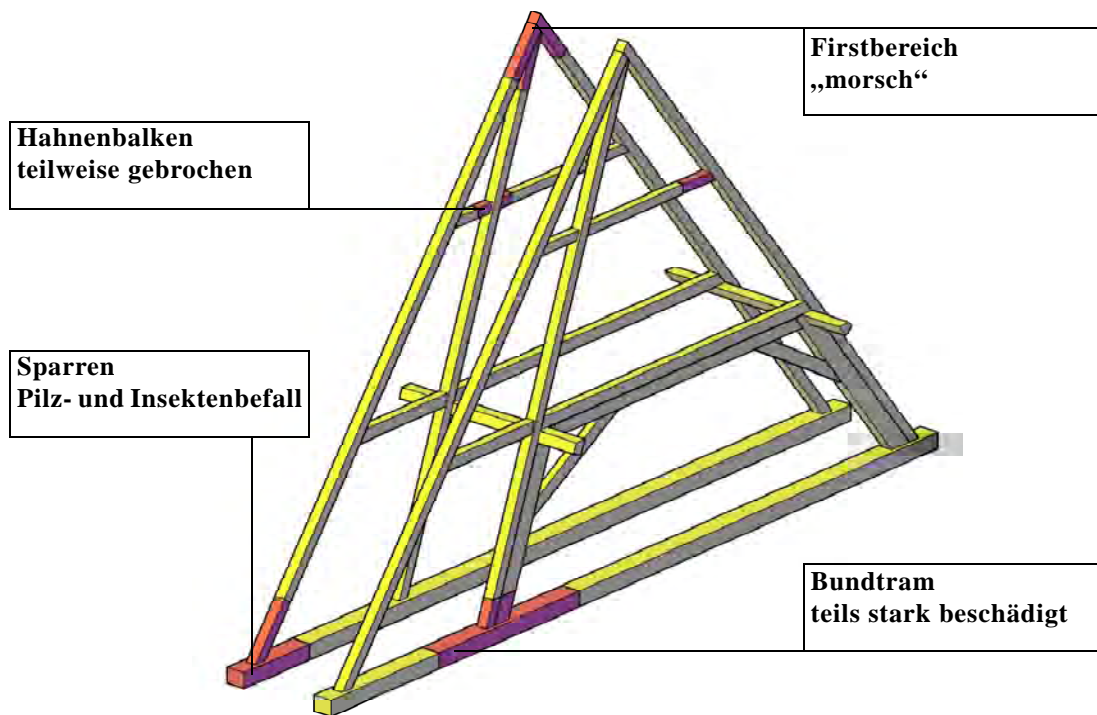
Schadensbereiche im erfassten Dachstuhlbereich
